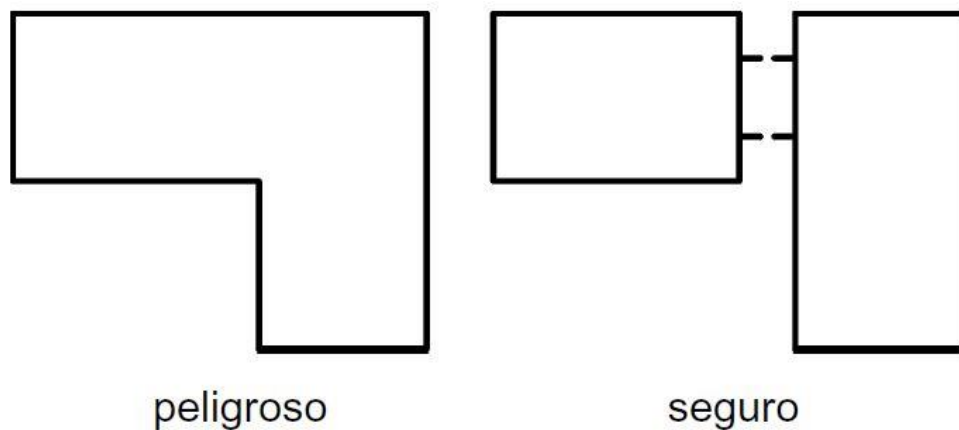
Forma de la planta. Adaptado: Manual de construcción para viviendas antisísmicas
